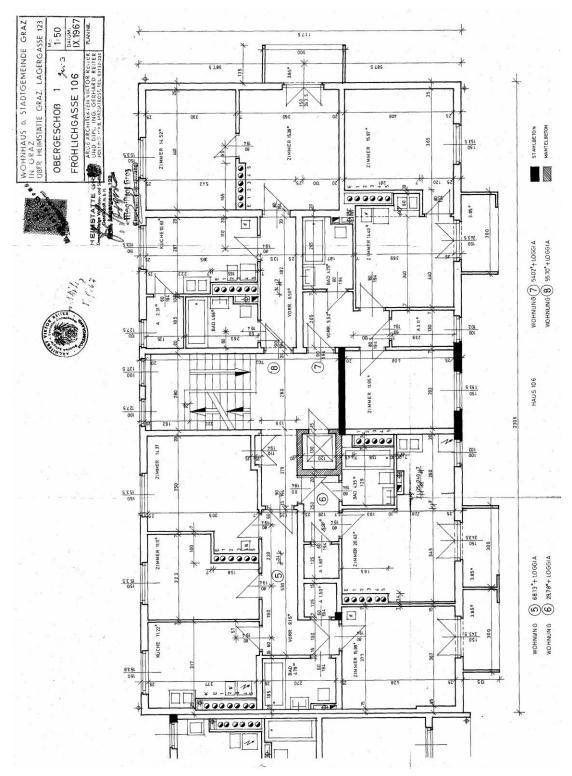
Grundriss - 1. Obergeschoß 49
